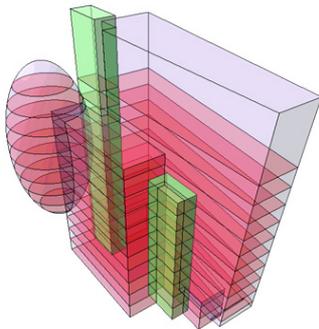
Ähnlich dieser Abbildung (Revit) könnte ein Navigator sich dem Anwender präsentieren. Geschosse, Fassaden etc. können direkt „angefahren“ (eingezoomt) werden. (Architekten-)Schnitte können angelegt, verändert und ausgeführt werden. Höhenangaben wirken sich auf das gesamte Modell aus. Je nach gewünschter und auch vorhandener Informationsdichte sind neben den GEs (vertikal) auch Aufteilungen in den Geschossen (horizontal) darstell- und anwählbar.
